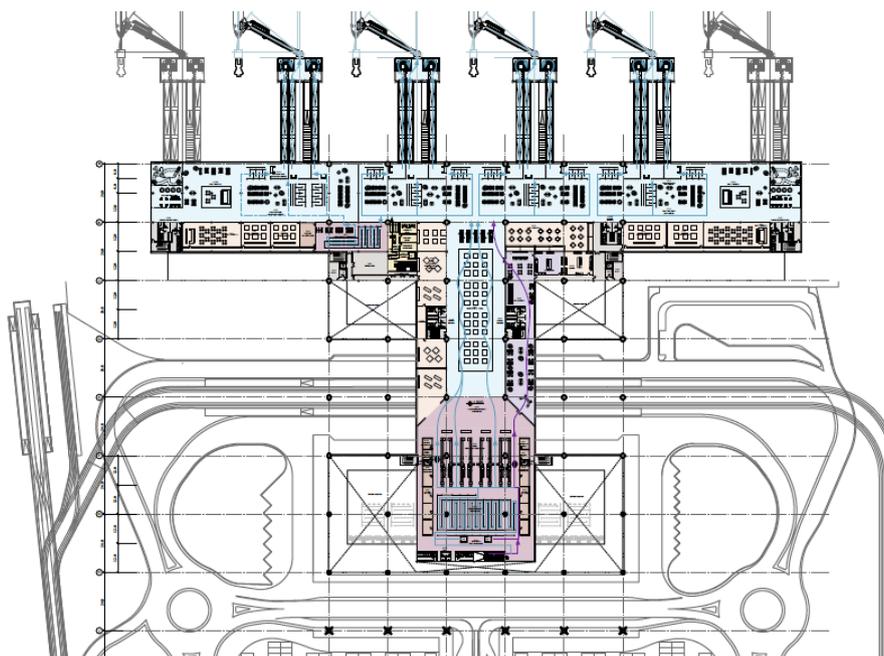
| Planimetria Piano Primo Terminal Anno 2026
